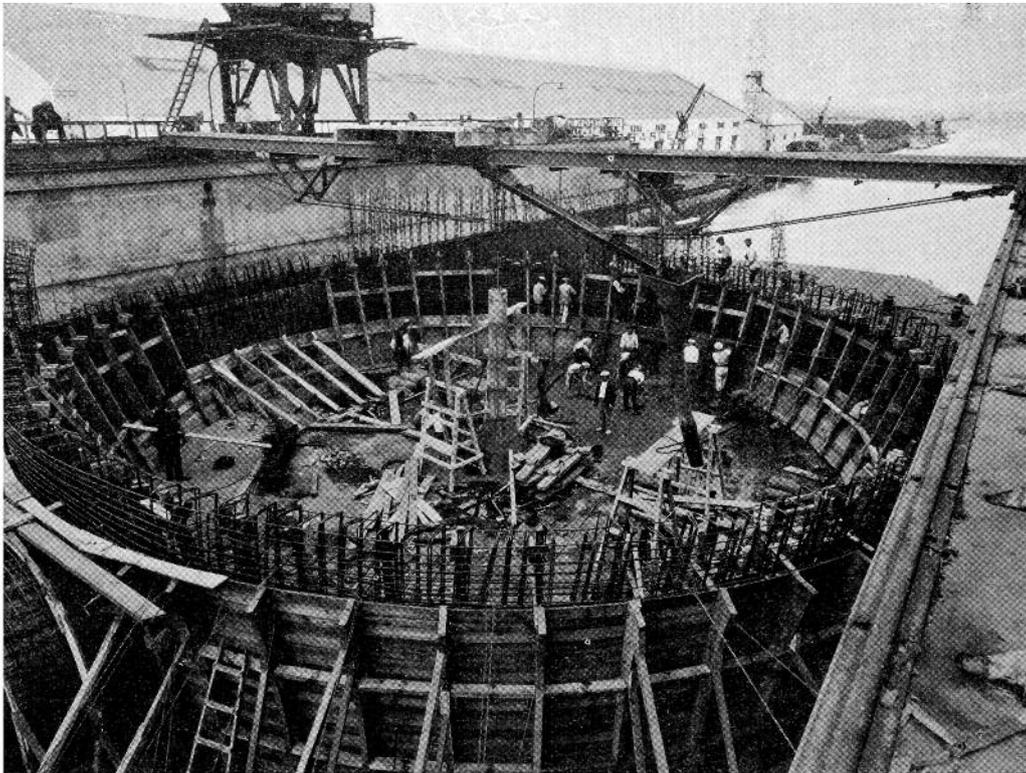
<sup>a</sup> Hormigonado de la Casa de Bombas. En el centro, la columna de apoyo del puente-grúa de servicio de la instalación de agotamiento
